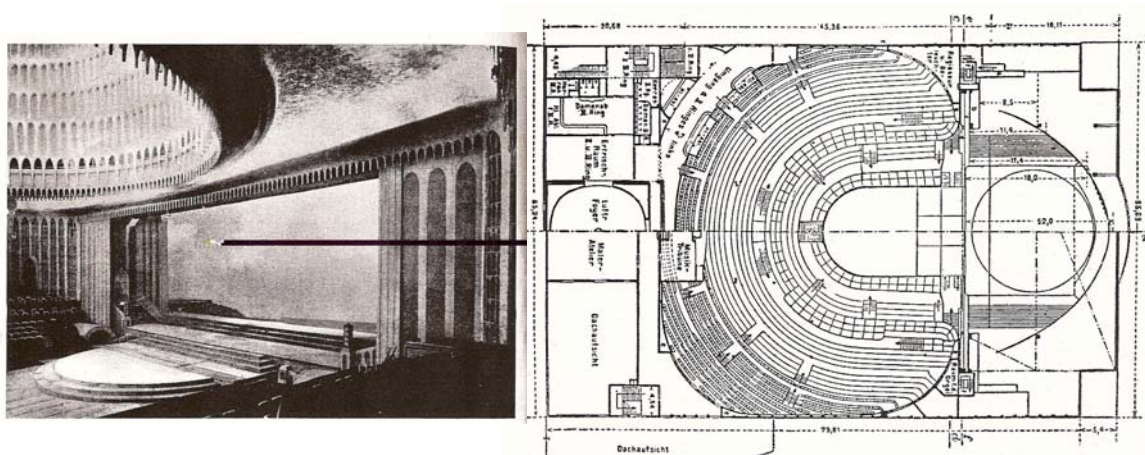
Desenho e Planta do Teatro Grosses Schauspielhaus, de Hans Poelzig (1919)
